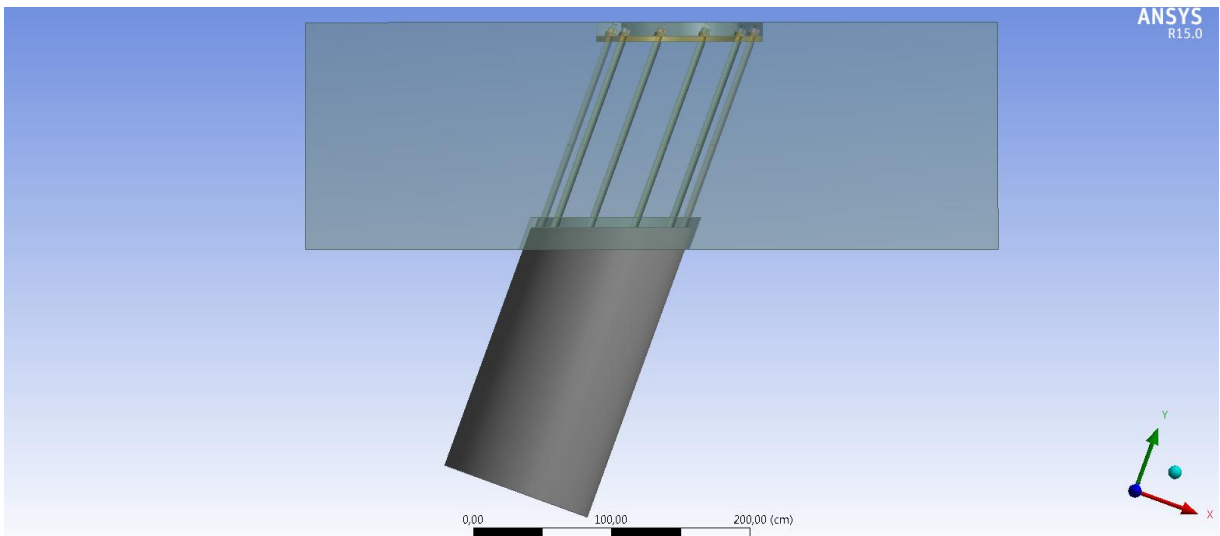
Vista frontal de conexión con pilote inclinado.
